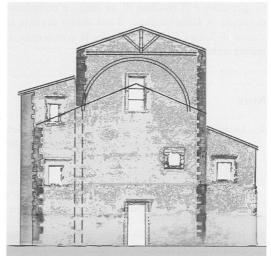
Sovrapposizione prospetto ovest e sezione trasversale schematica (disegno dell'autore 2013)
